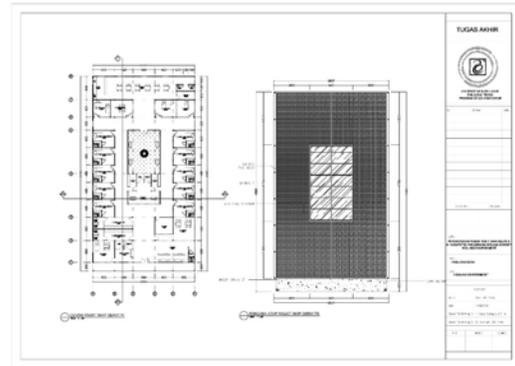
Denah dan Tampak Atas Bangsal Rawat Inap Kelas 2
